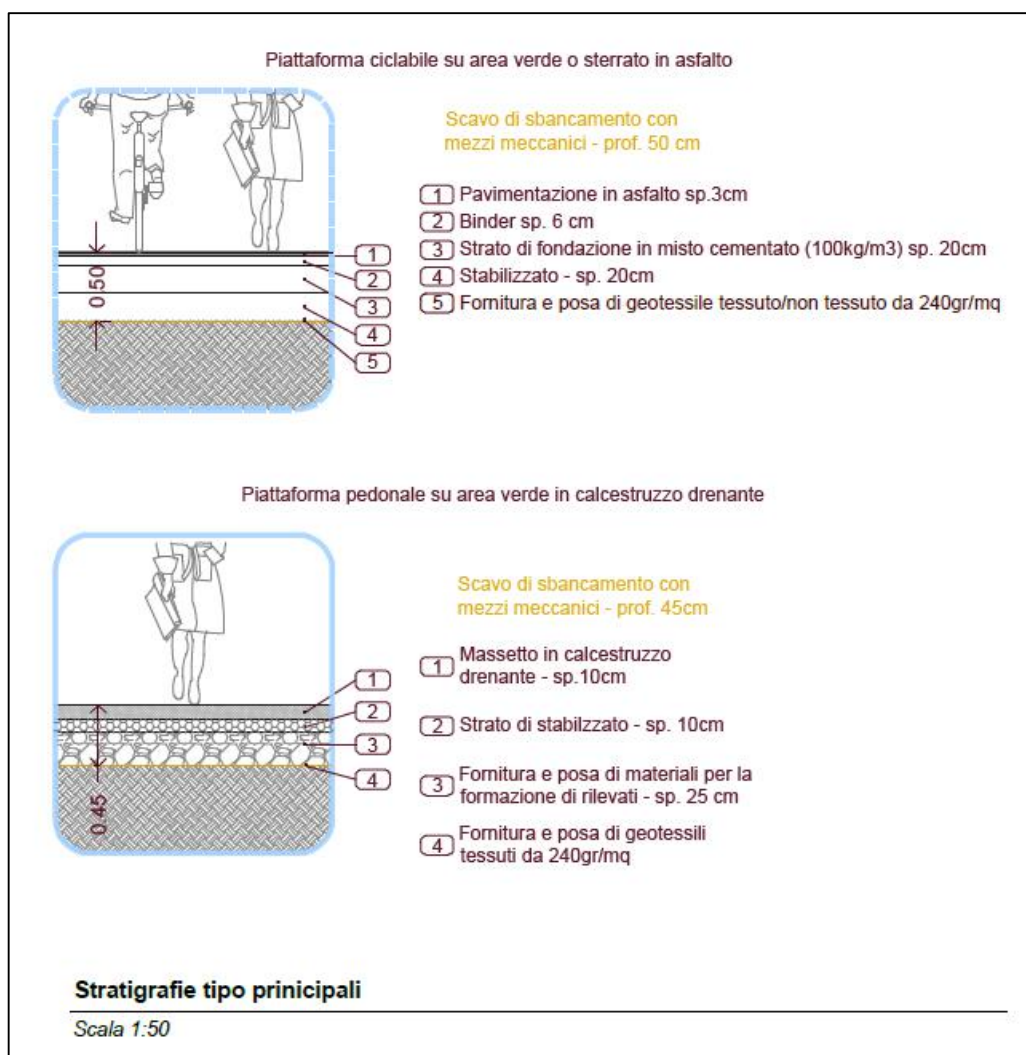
Particolari costruttivi della ripavimentazione di tutto il tracciato di Ciclovía Tirrenica oggetto di studio
